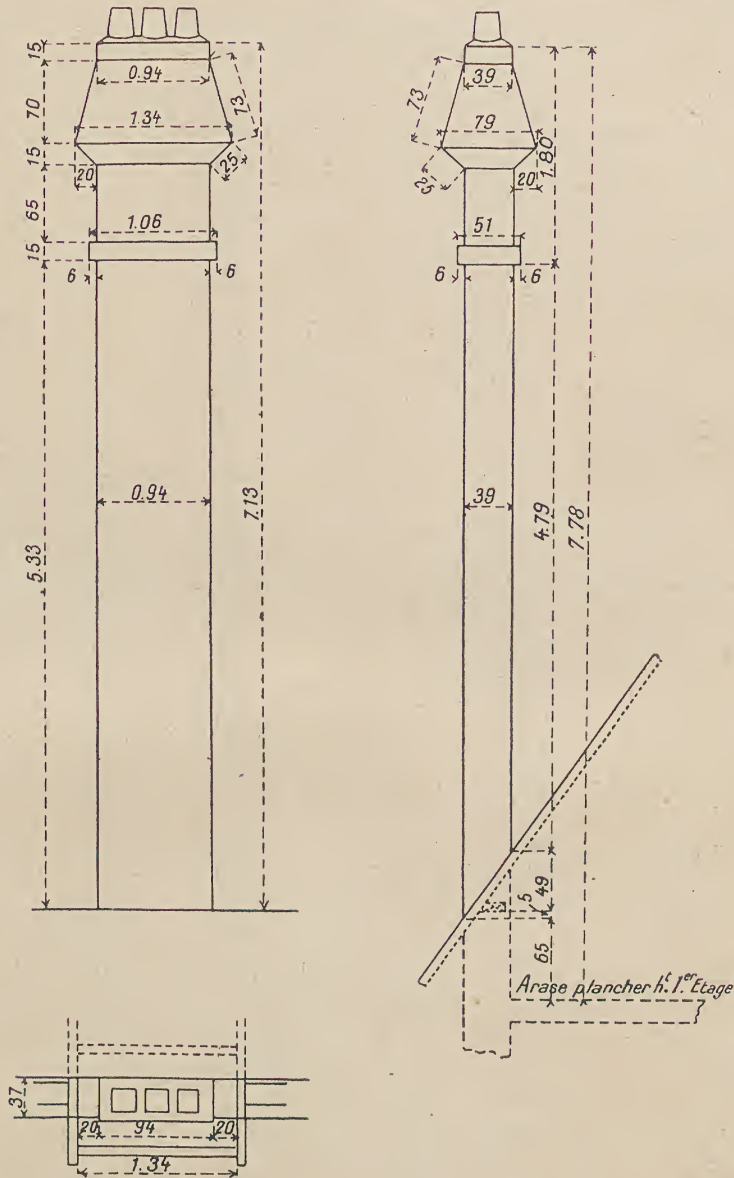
à 747. — Souche de cheminée sur façade postérieure, vue de face et de côté et plan.
